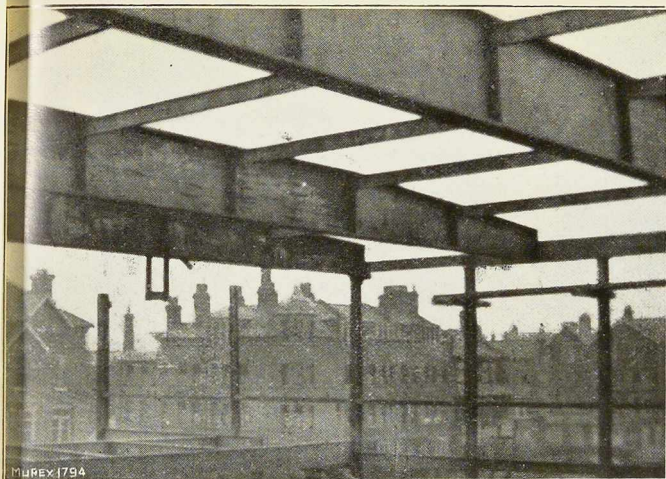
Les poutres à âme pleine de la toiture du hall. On voit l'assemblage qui recevra les tirants portant le deuxième étage.
